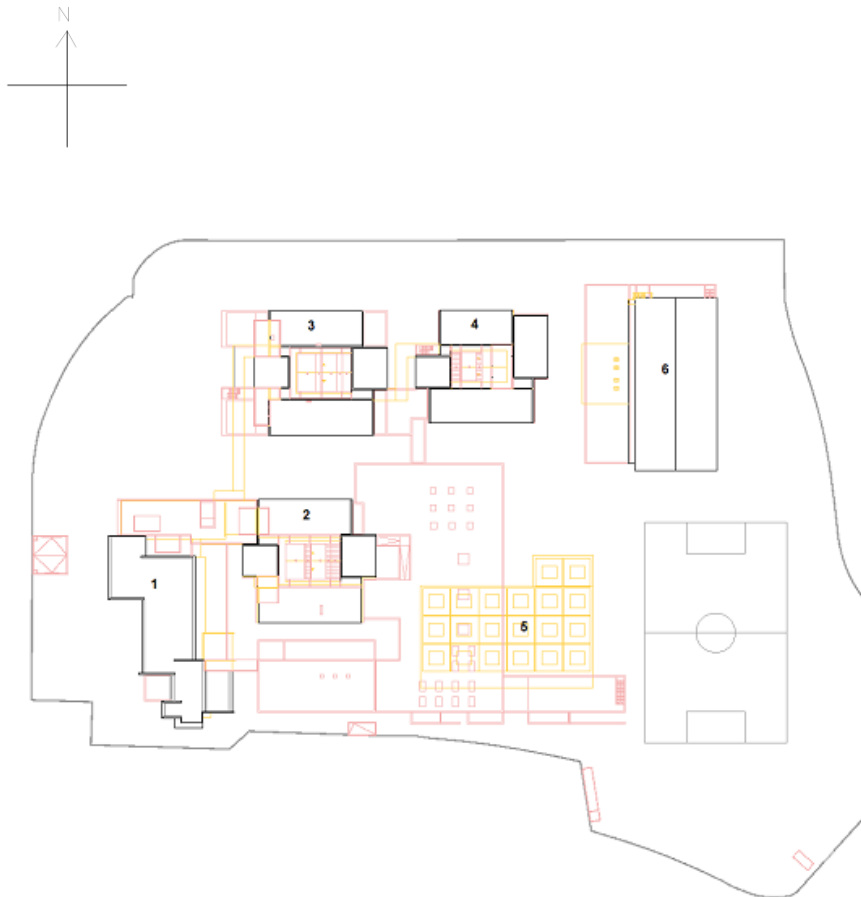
Planta da Escola de Loulé antes da intervenção sofrida.
